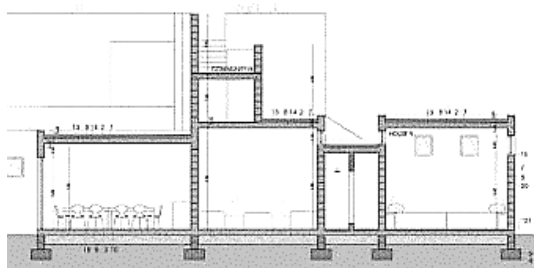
ESQUEMA DE SECCIÓN CONSTRUCTIVA TIPO
